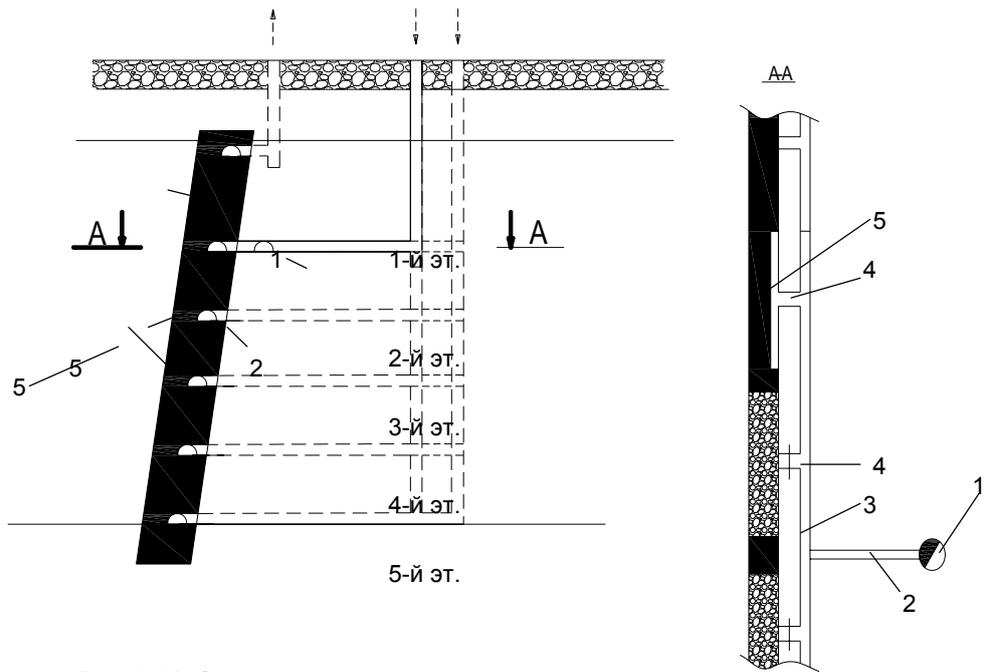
Схема вскрытия мощного крутопадающего пласта
